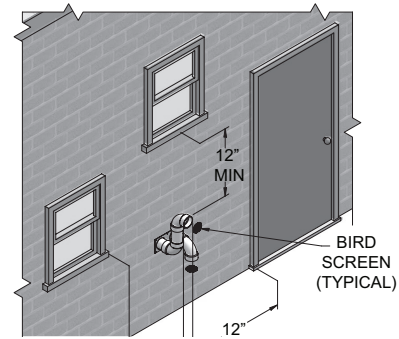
D Disposition de ventilation alternative - terminaison latérale en acier inoxydable typique d'évent et d'air avec raccords fournis sur place
